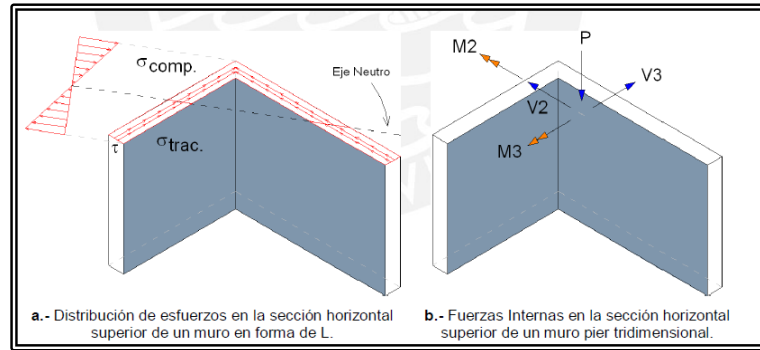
Esfuerzos en un muro bidimensional y sus fuerzas internas para un Muro Pier
